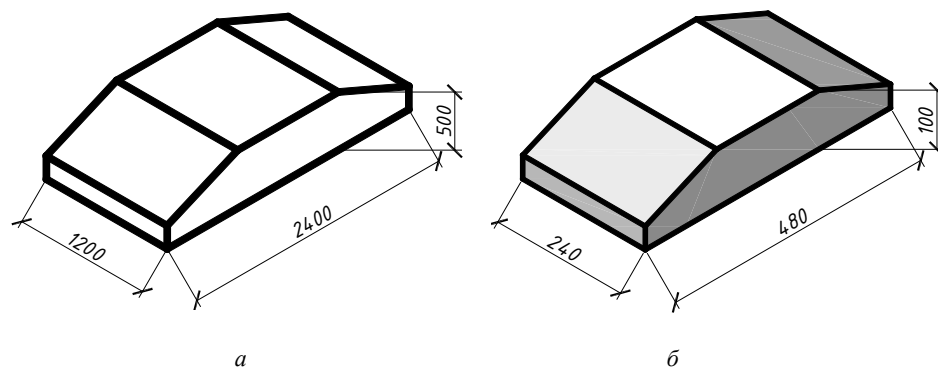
Железобетонные модели фундаментов: *а* — по серии 1.112-1; *б* — железобетонная модель
